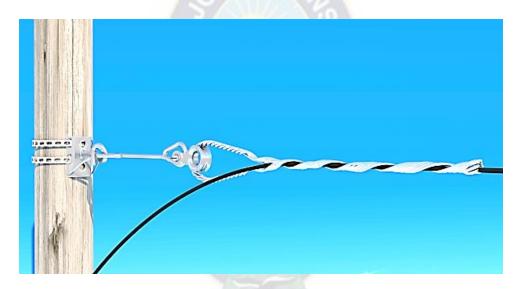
Ferretería de retención de fibra tipo terminal Fuente: (Conimel, 2020)
